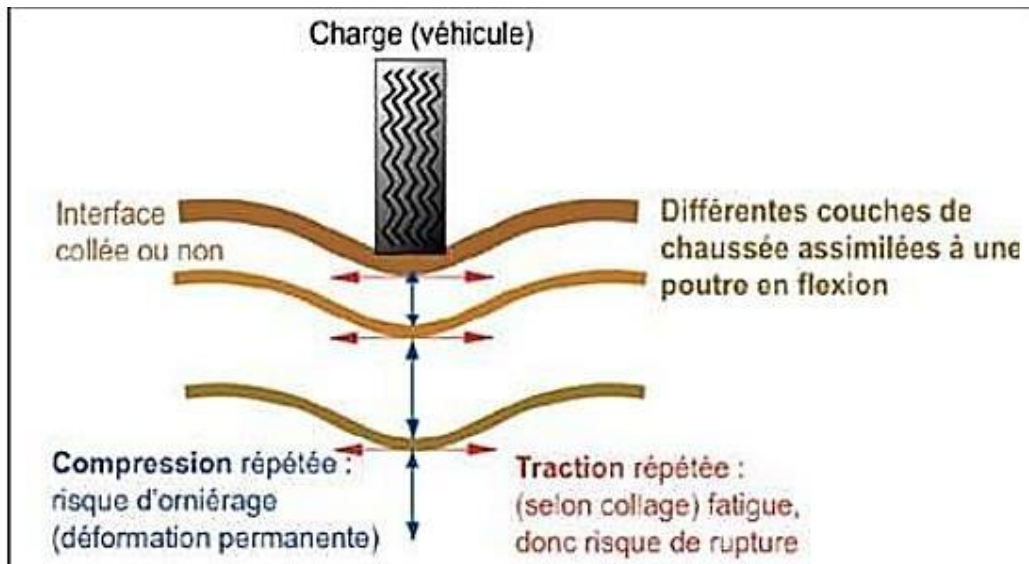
Schéma de fonctionnement d'une structure de chaussée sous l'application d'une charge roulante, d'après Abdo (2009) [5].
